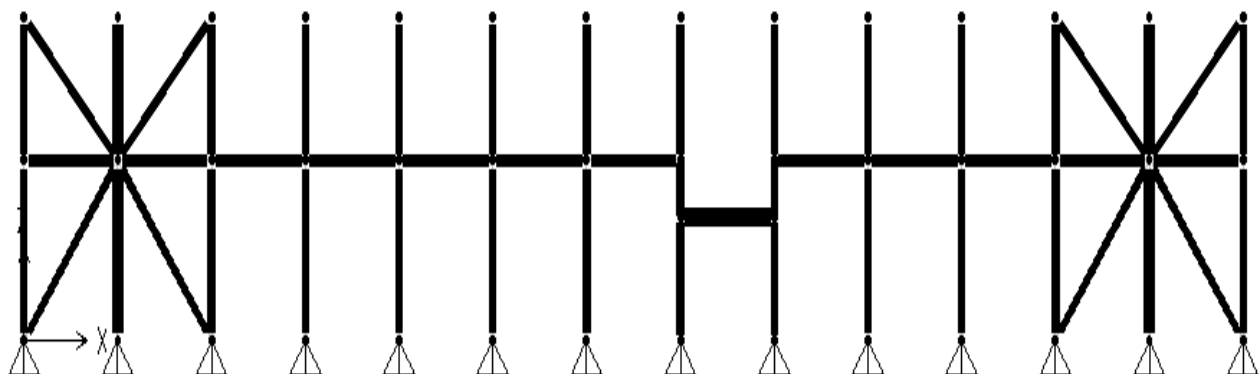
Pórtico A reforzado con riostras y encamisado de columnas
